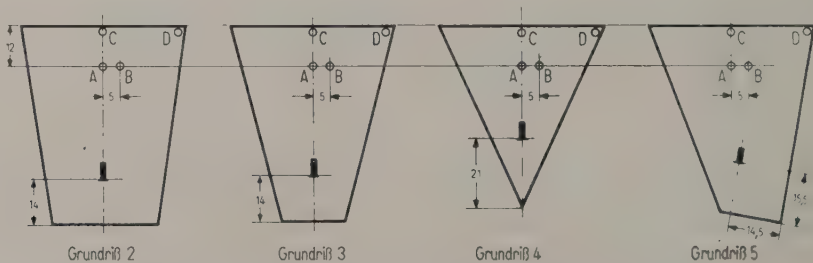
Modellraumgrundrisse und Lichtquellenorte.
